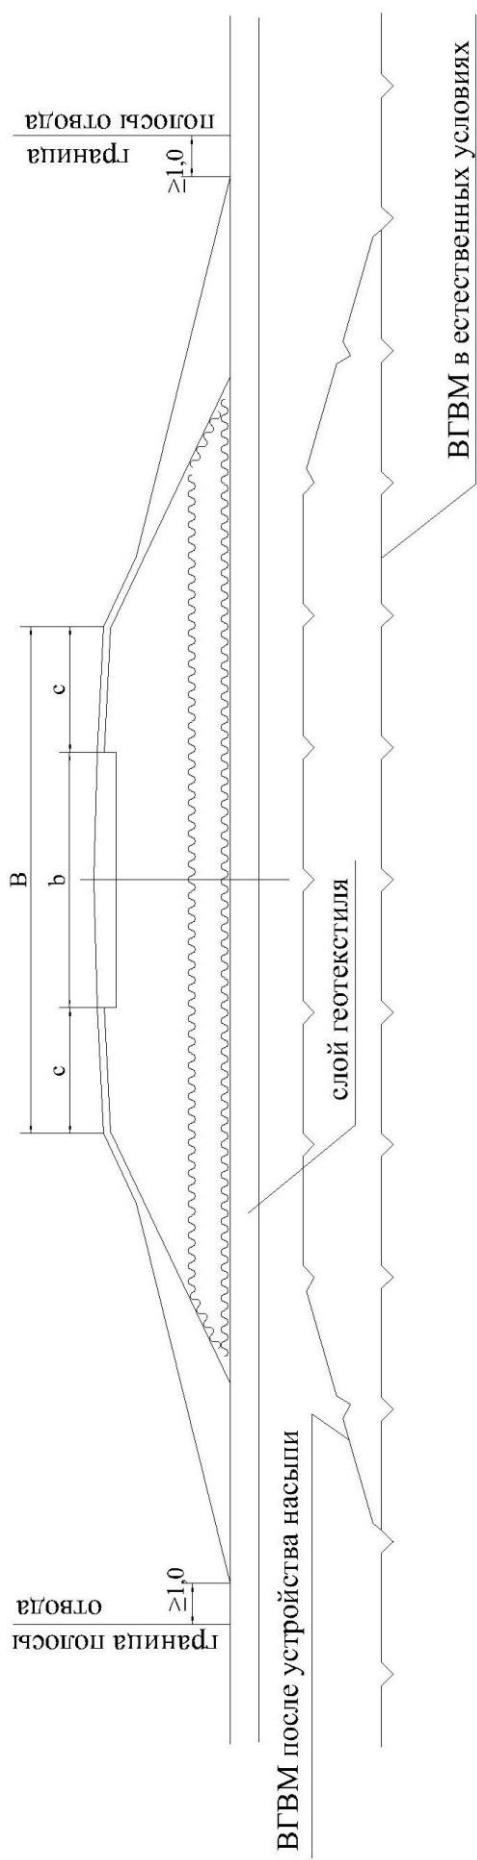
Насыпи с применением армирующих слоев из геотекстиля типа 13-М
